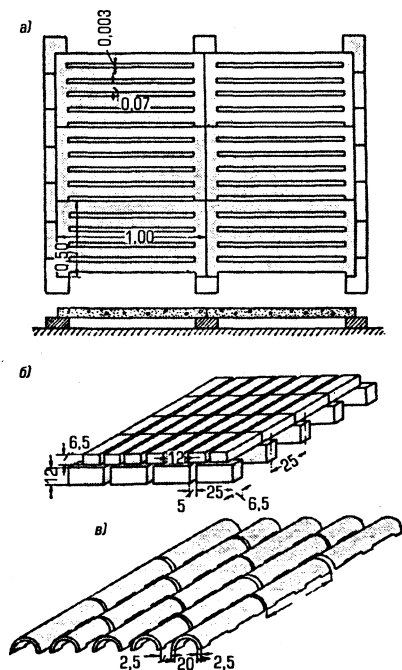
Устройство дренажа биофильтров: а — железобетонные плиты; б — кирпичи; в — керамические трубы
